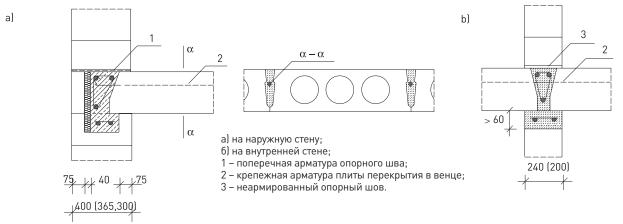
Опирание многопустотных плит перекрытий из обычного тяжелого бетона
